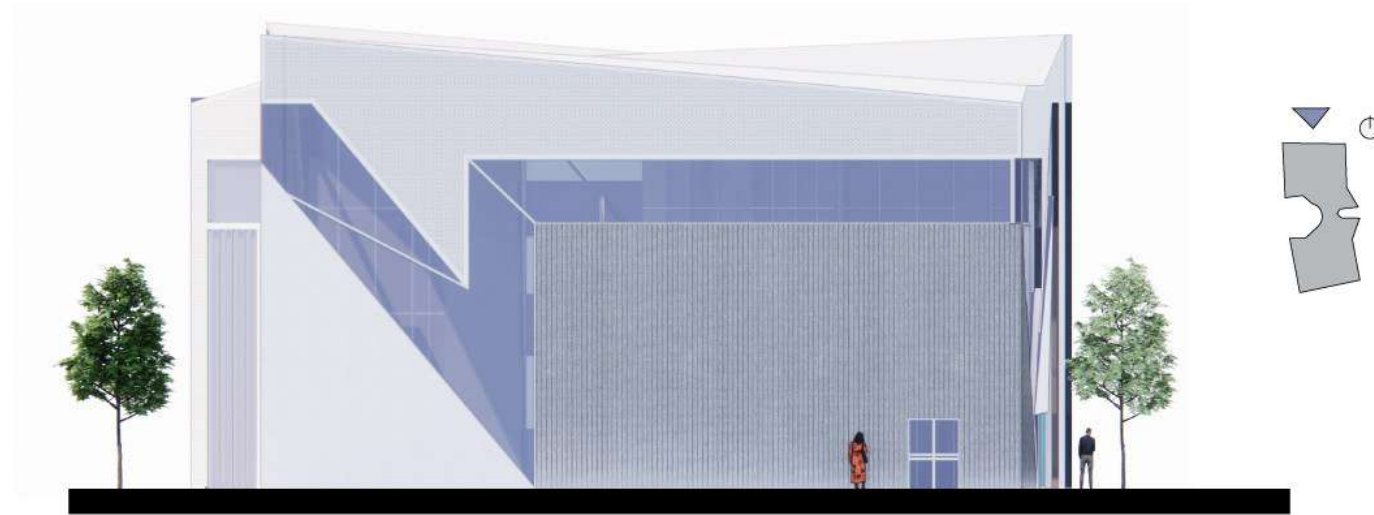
Alzado frontal y lateral derecho, edificio B, elaborado por autor, 2024.
